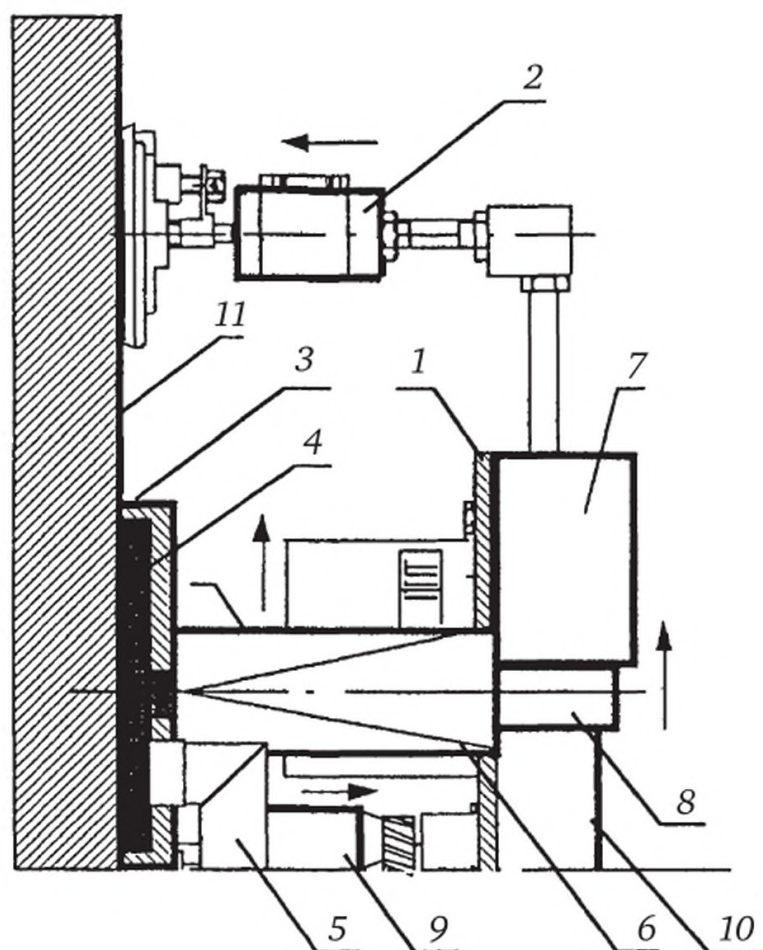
Очистка и шлифовка вертикальных поверхностей:
